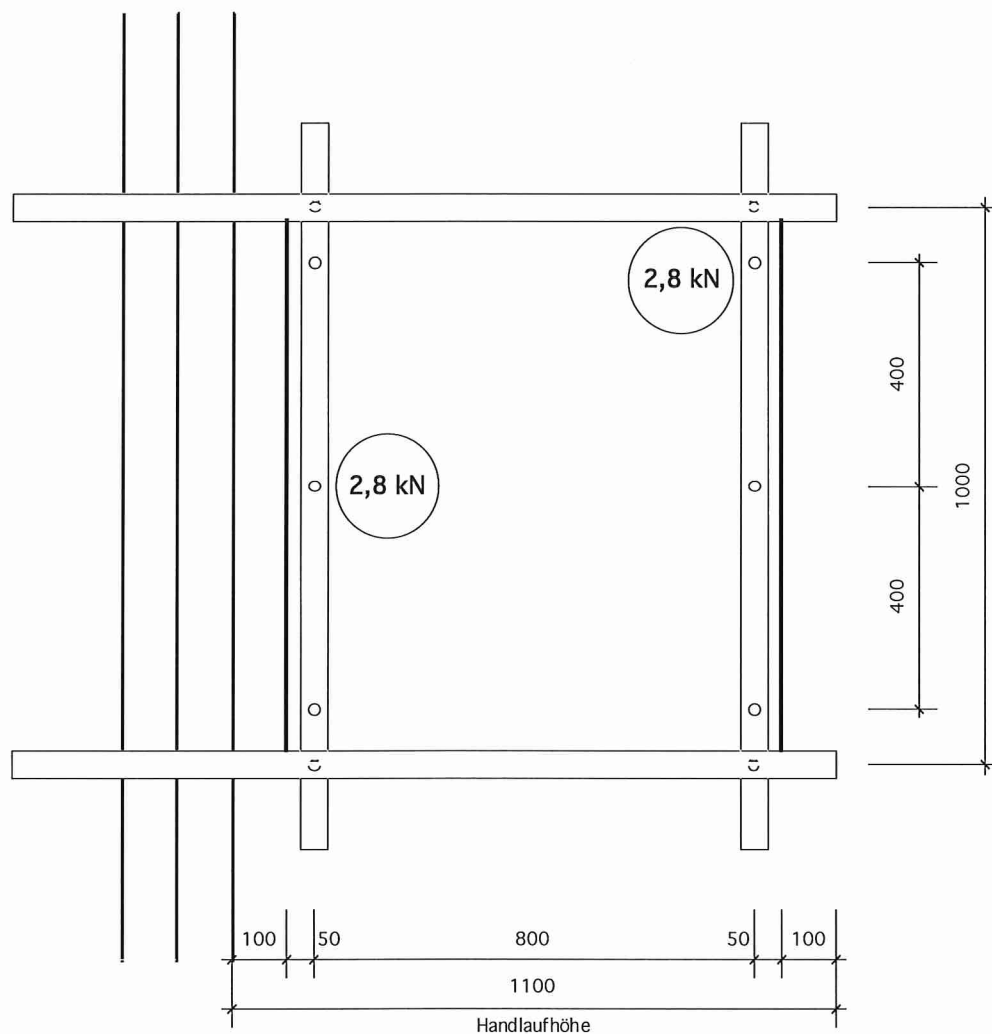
Prüfung des Befestigungselementes bei 1100 mm Handlaufhöhe
